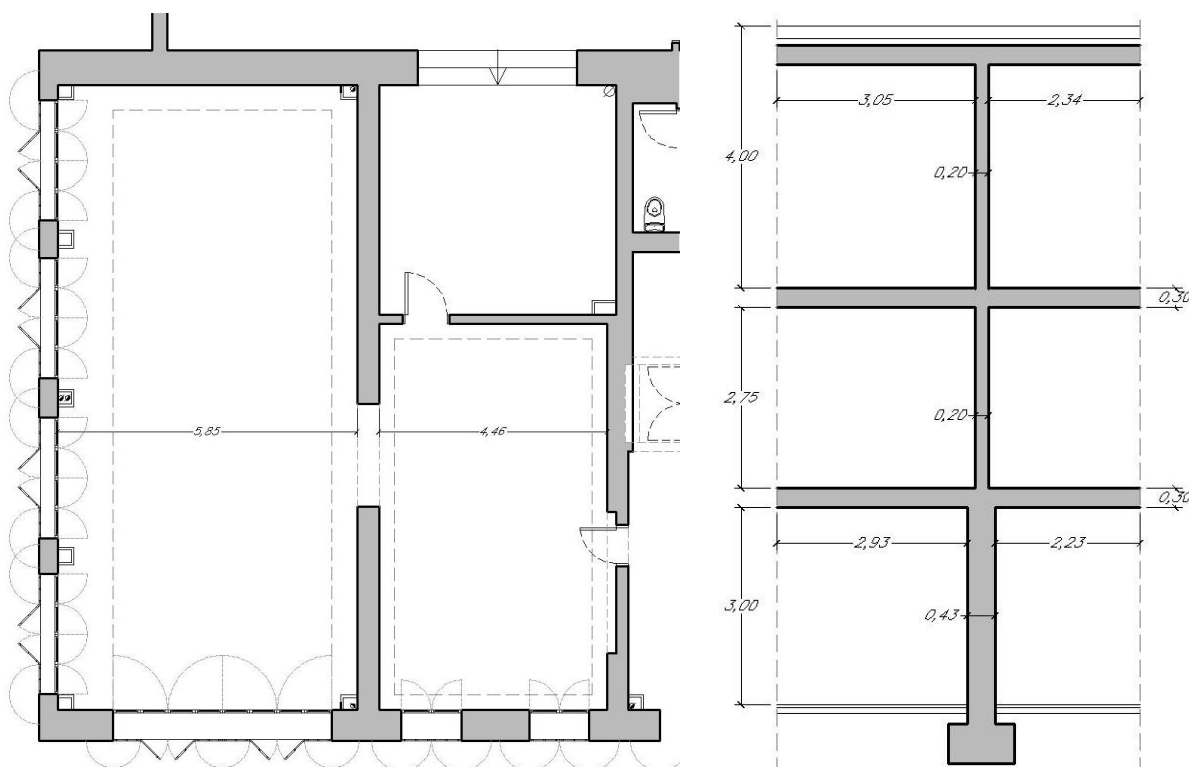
Planta y sección del apeo estudiado (Fuente: Propia)
